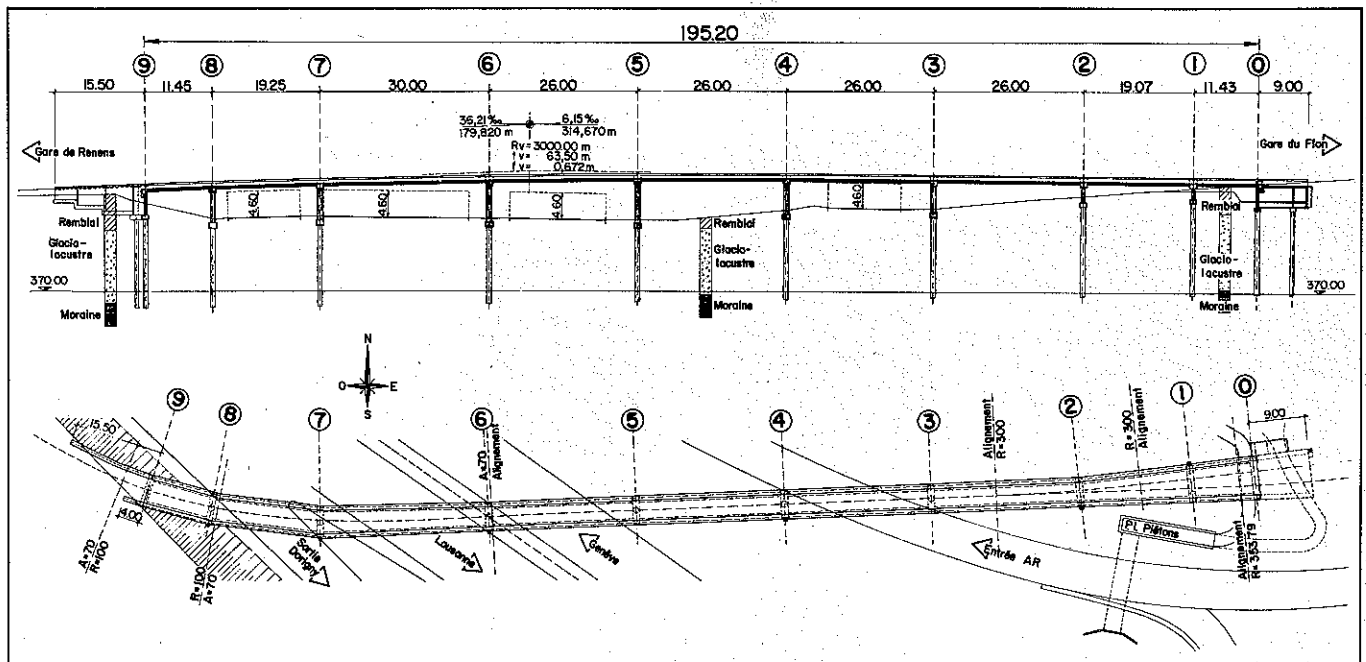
Pont de La Bourdonnette: plan et coupe en long.
